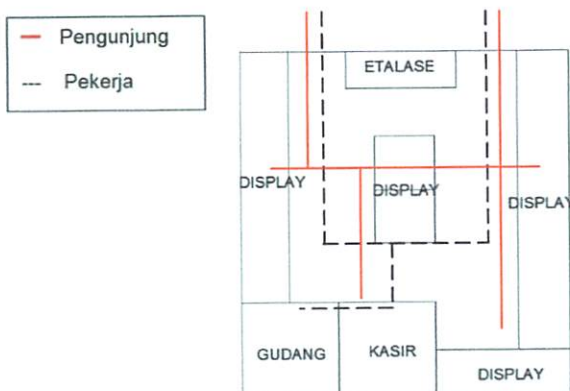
Denah Hubungan Ruang Toko Sepatu
